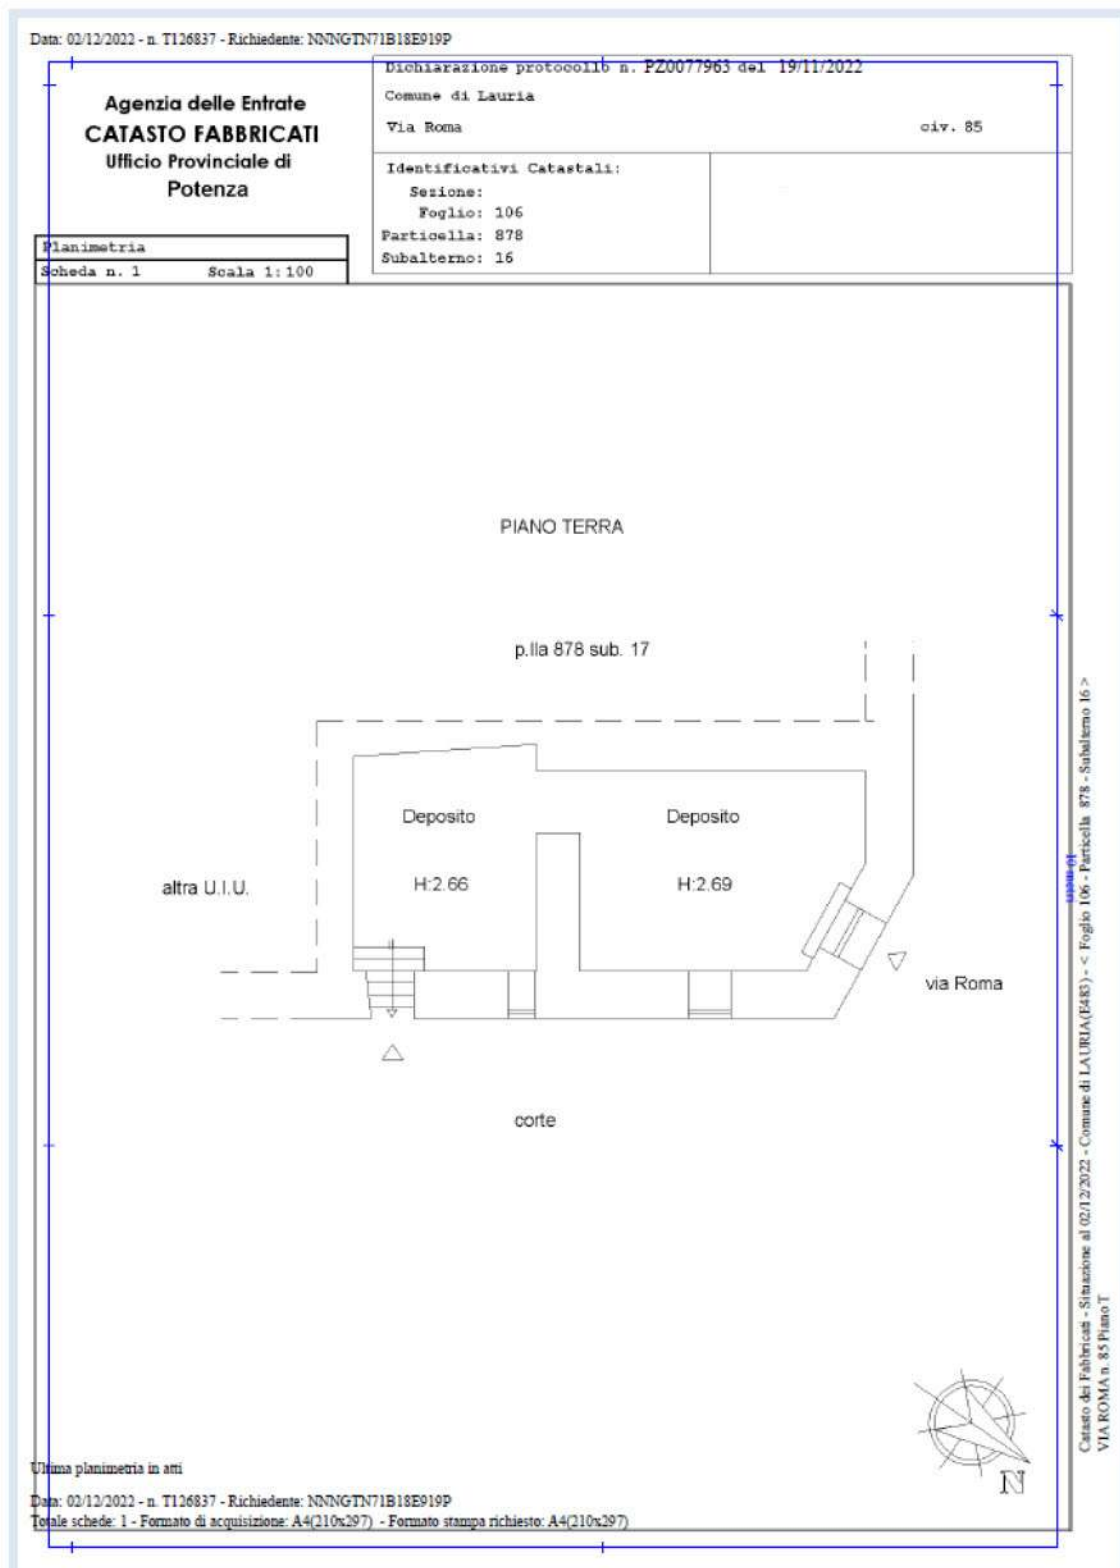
Planimetria “aggiornata” Unità Fg. 106 P.lla 878 sub. 16
